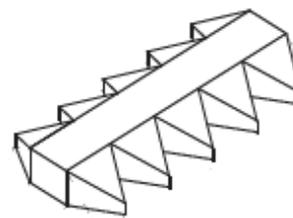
Фундамент с ломаным очертанием краевой зоны
